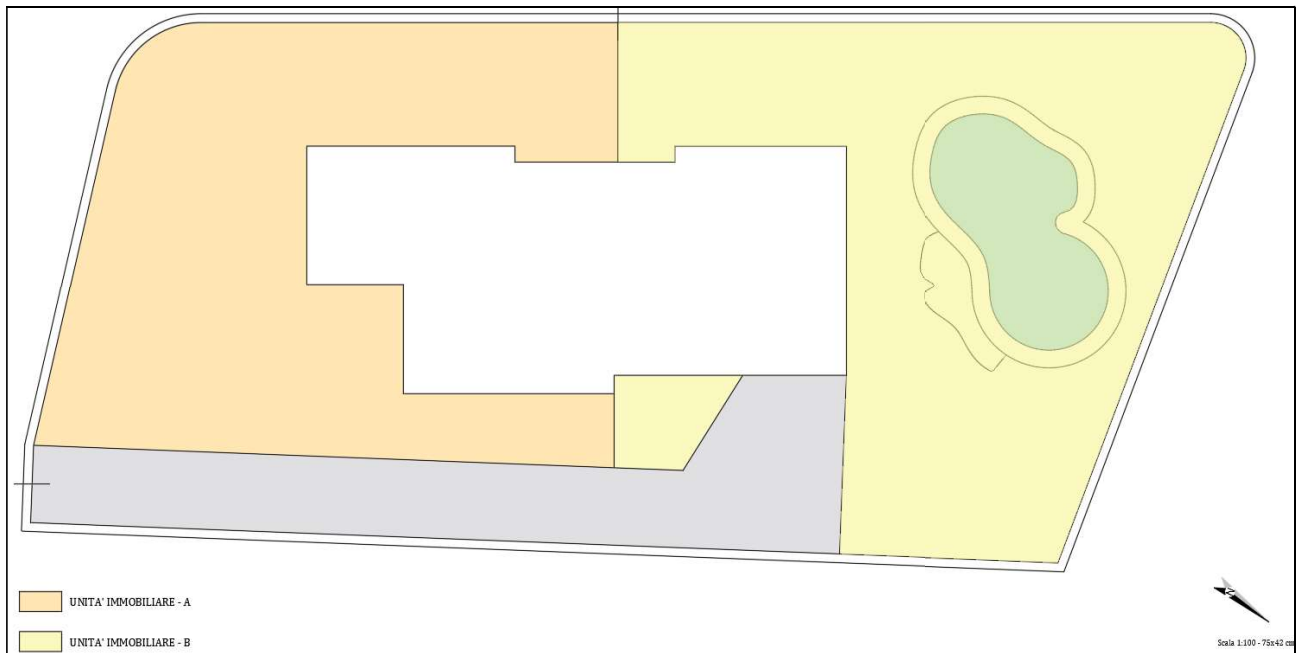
Planimetria dell'immobile PROPOSTA DI DIVISIONE – Giardino
